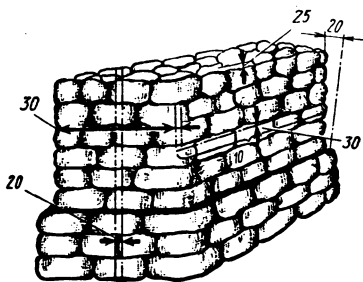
Допускаемые отклонения при кладке фундаментов из буттового камня (штрихпунктирными линиями обозначены границы допускаемых отклонений)
